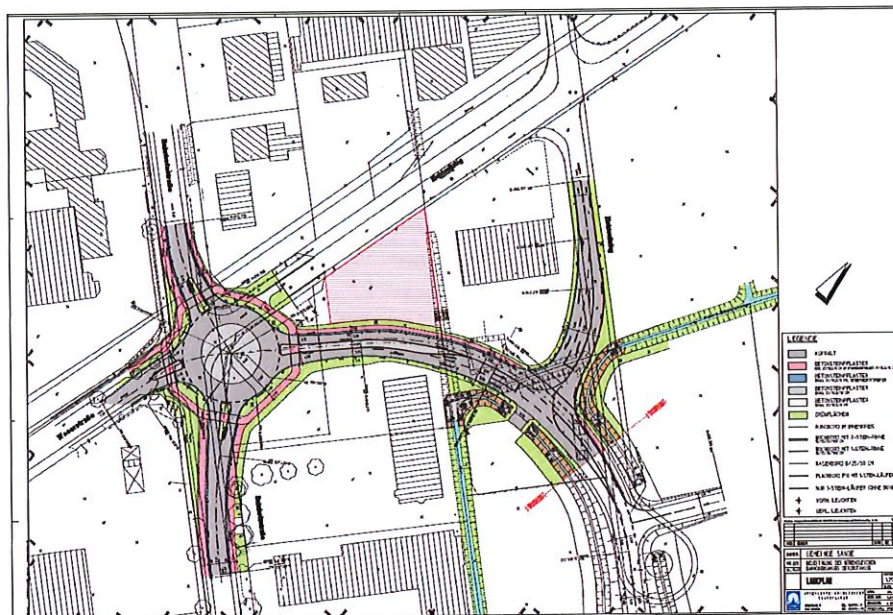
Lageplan Kreisverkehrsplatz Bahnhofstraße
